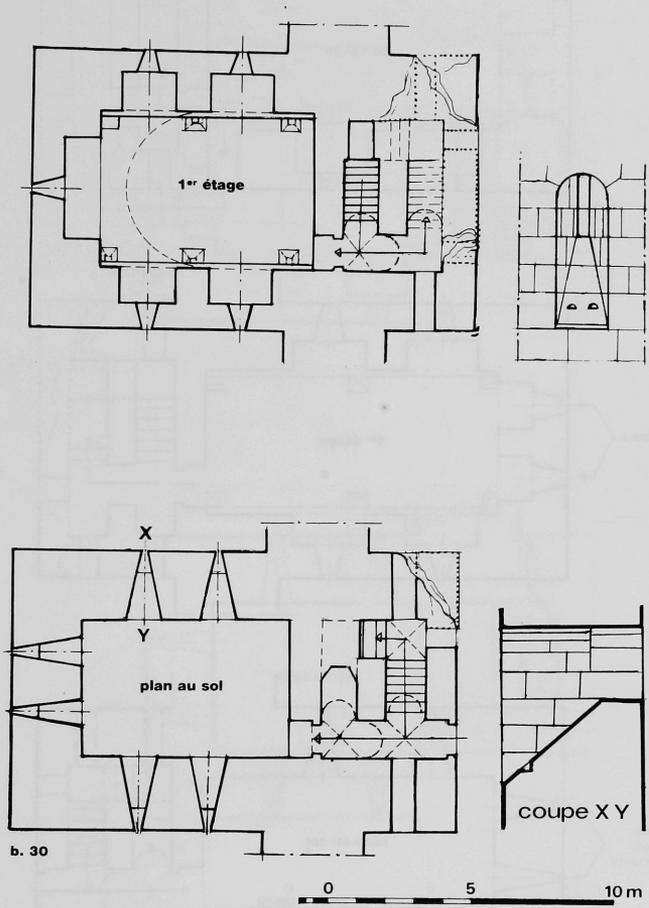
Bastion 30, plans au sol et du 1^{er} étage, détail d'une archère du rez-de-chaussée.
